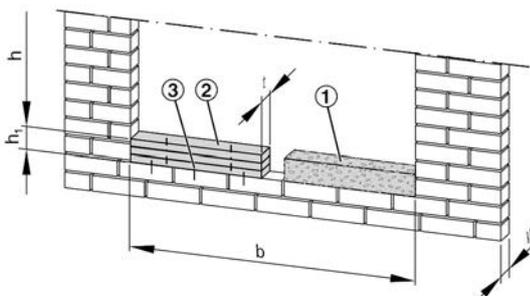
Ouverture de montage avec plaques en béton ou silicate de calcium pour l'ajustement en hauteur
